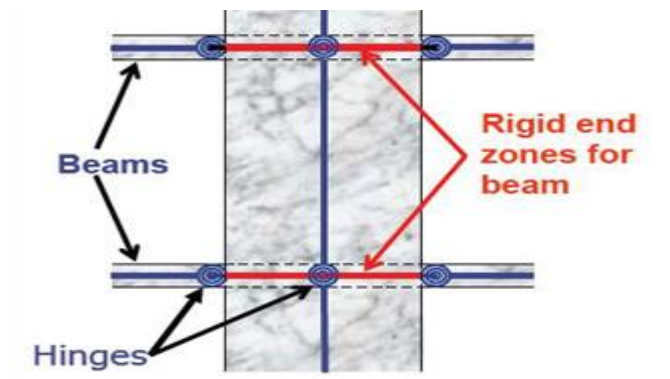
Modèle "Poteau-Poutre équivalent".
